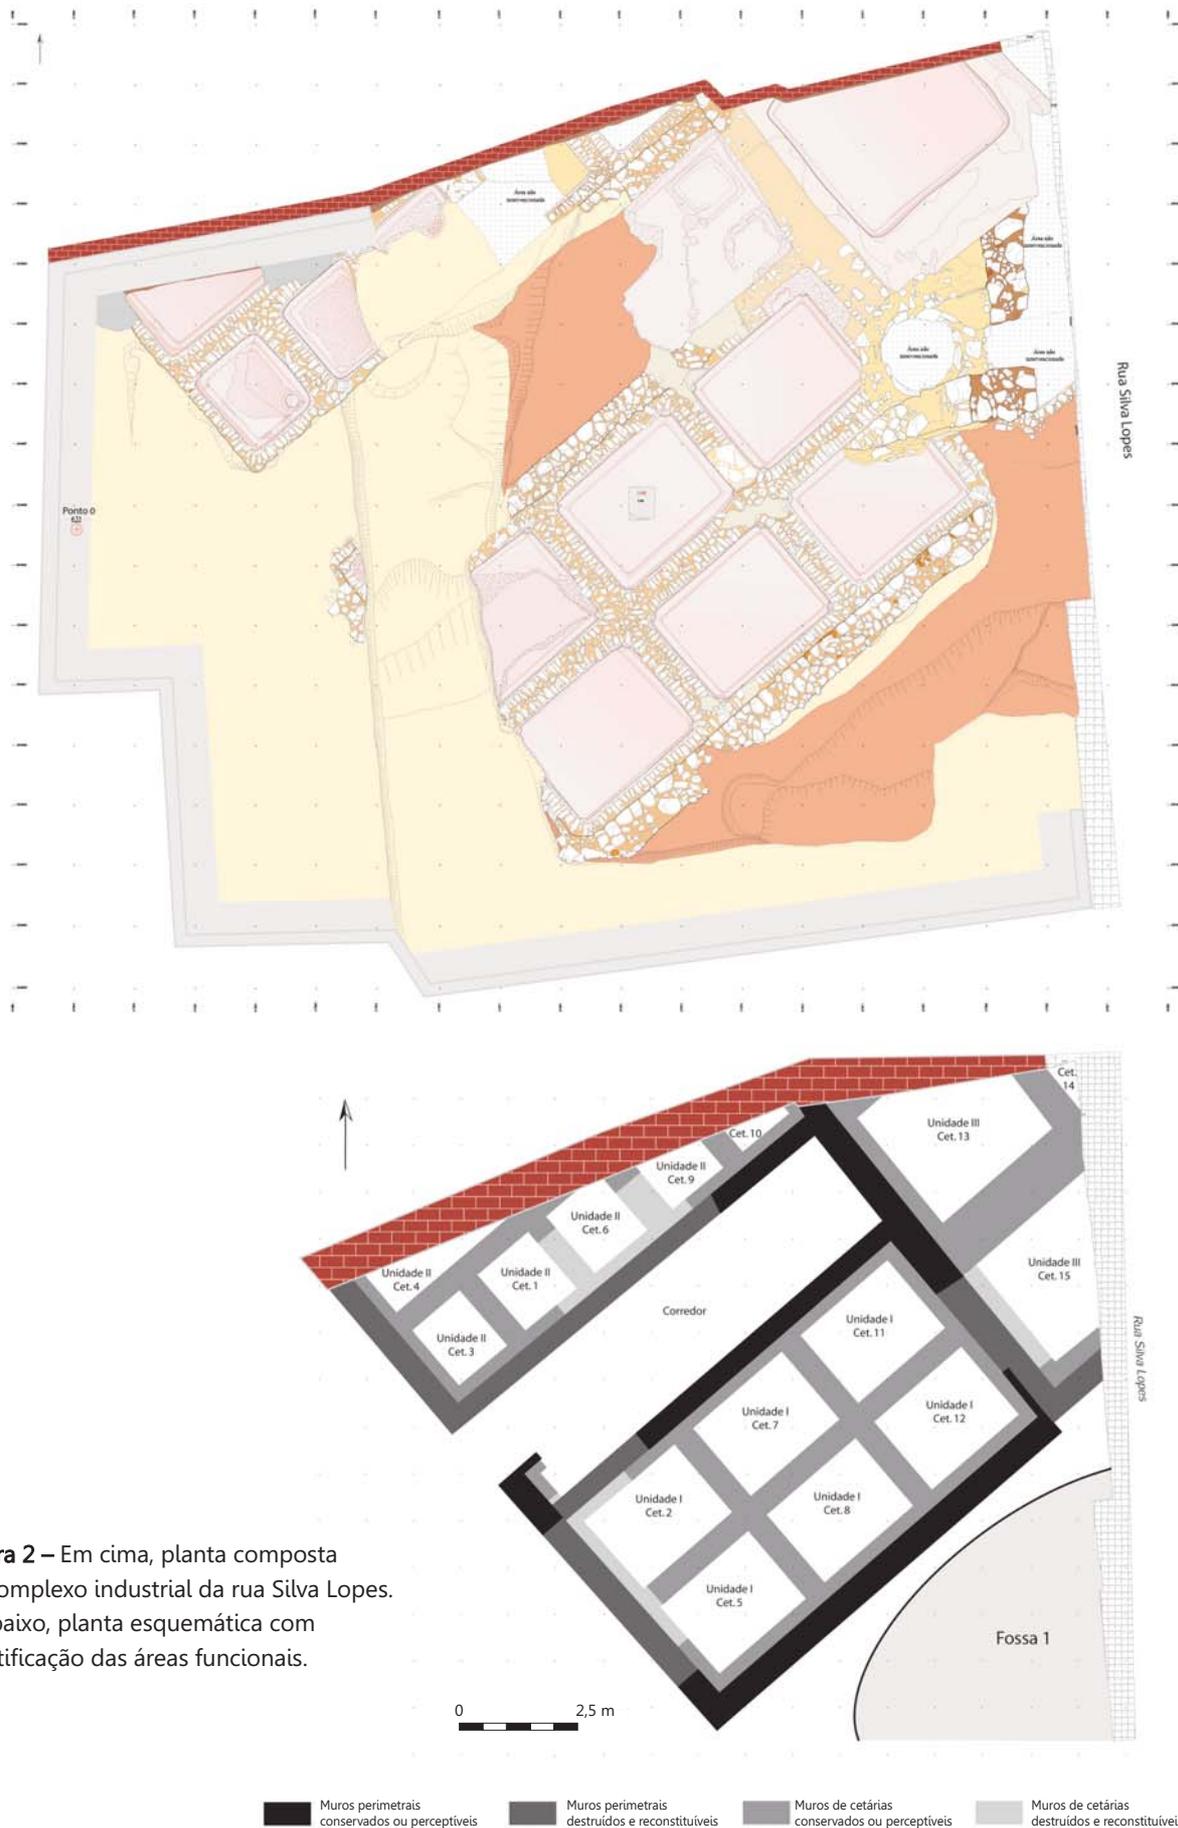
Em cima, planta composta do complexo industrial da rua Silva Lopes. Em baixo, planta esquemática com identificação das áreas funcionais.
